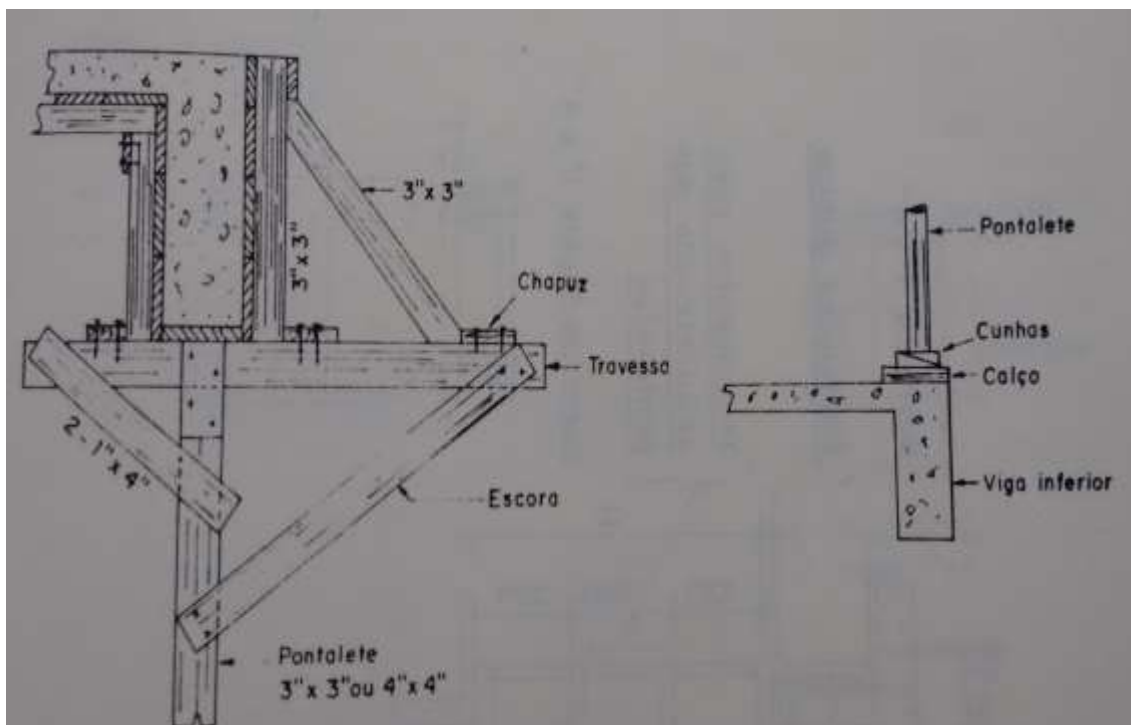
Detalhamento de fôrmas de madeira serrada para vigas com um pano de laje maciça.
